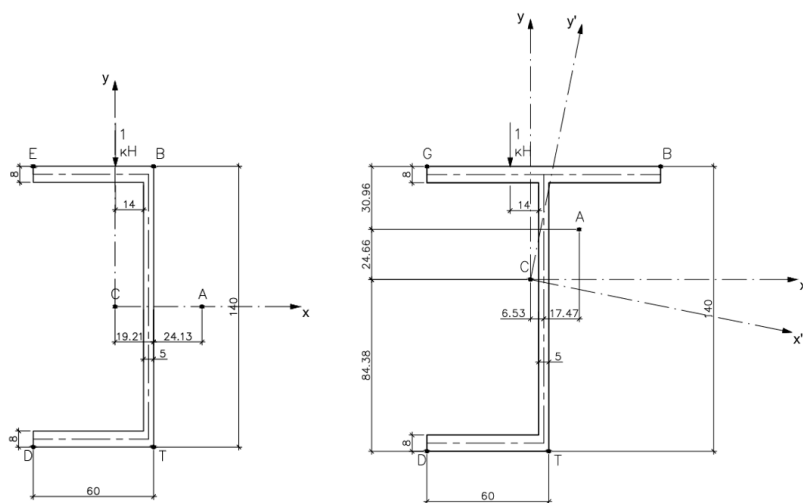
Поперечные сечения тонкостенных стержней открытого профиля
